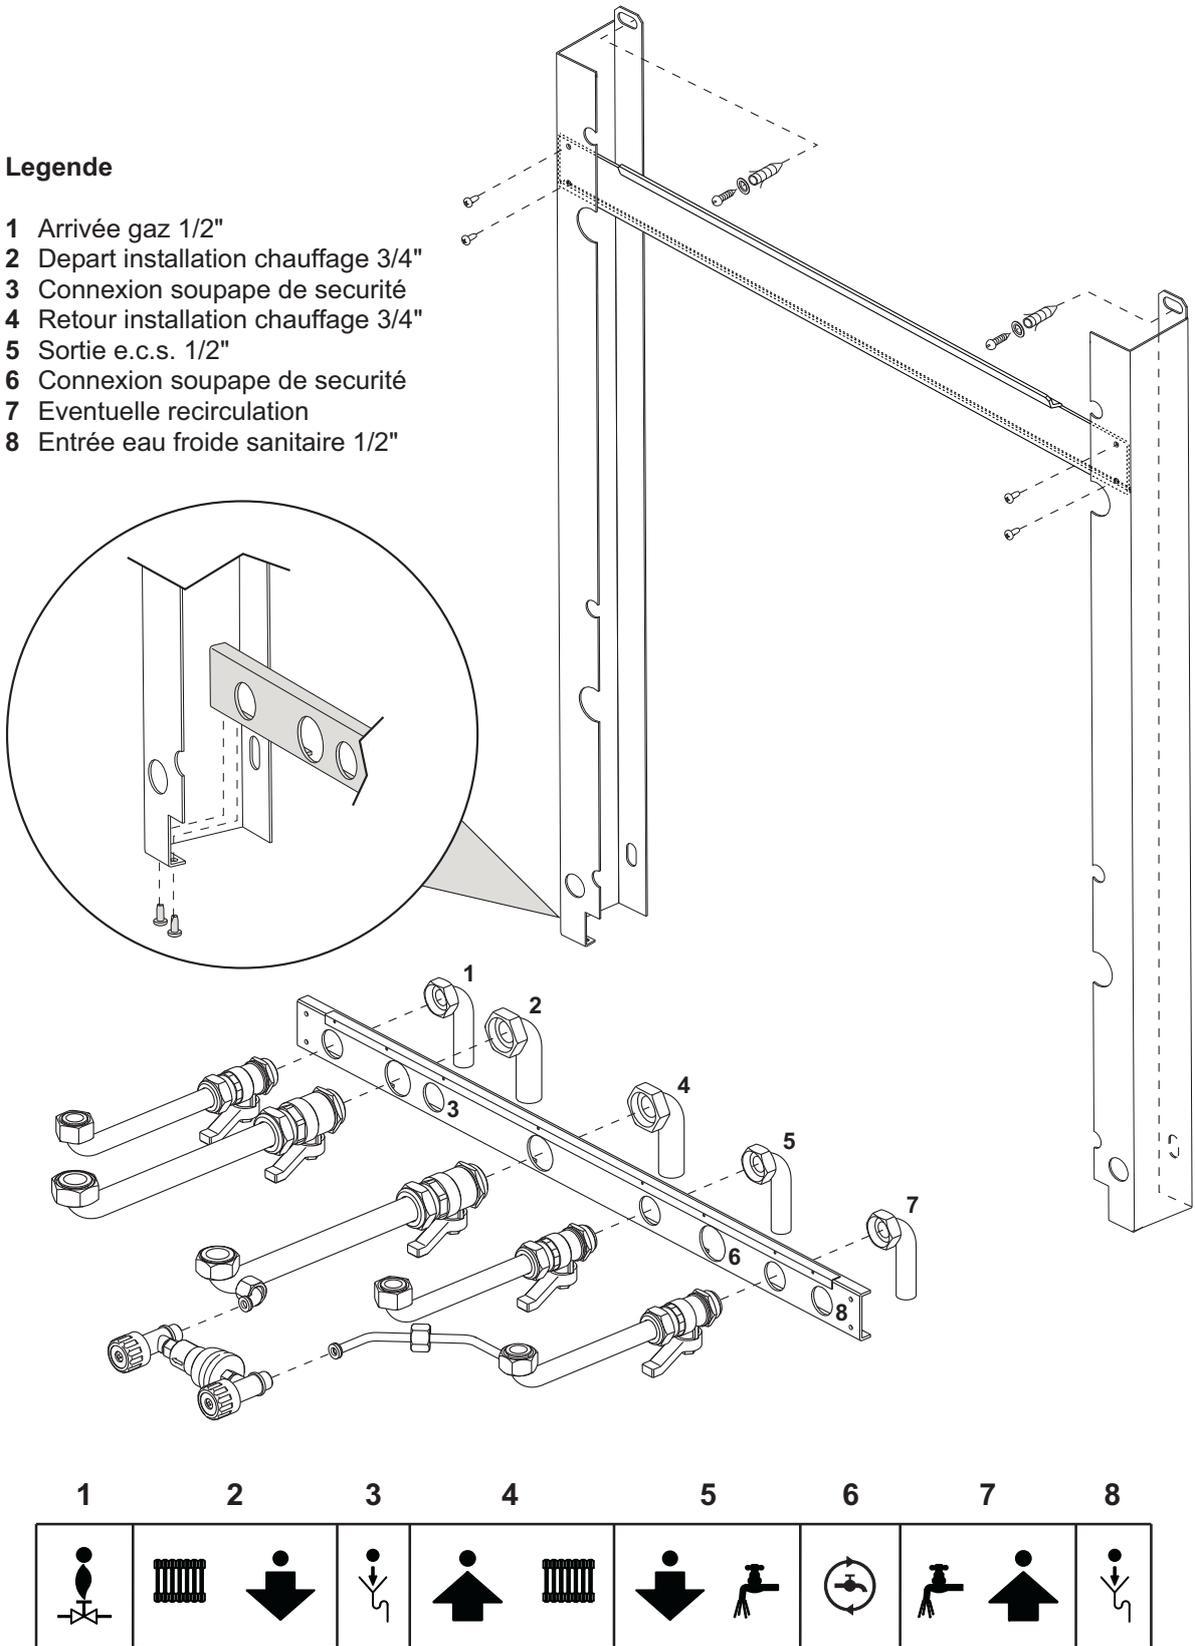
Kit Gabarit de montage avec Kit hydraulique
